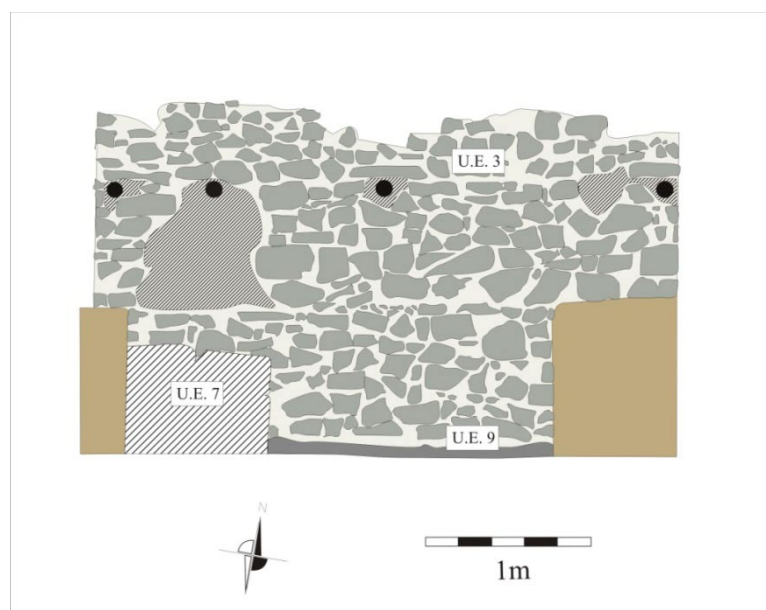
Alzado de un sector de muro perimetral norte (interior).
